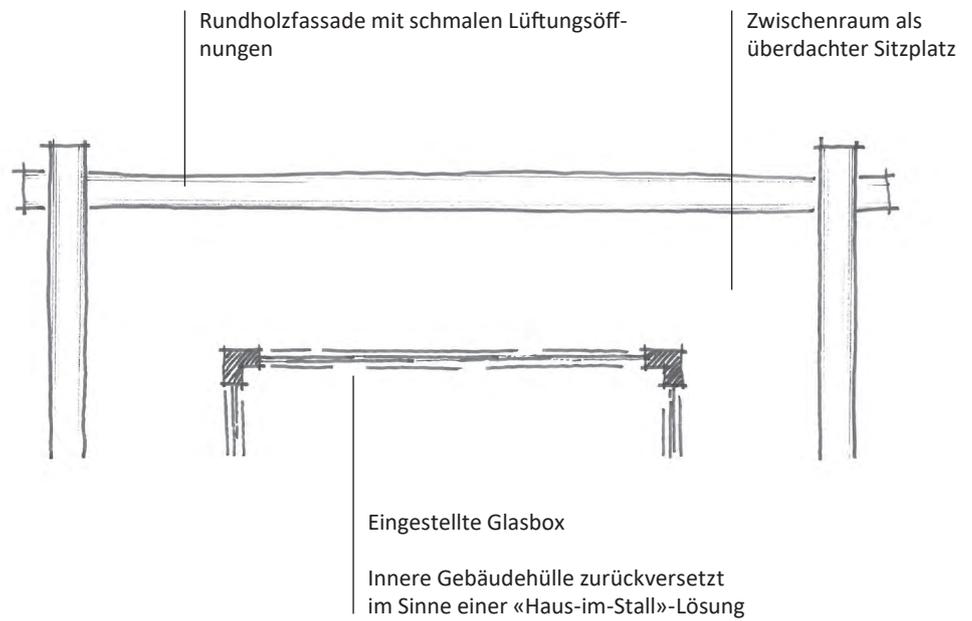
Prinzipskizze Heuraum: autarke Glaskiste in der Stallscheune (Grundriss).
